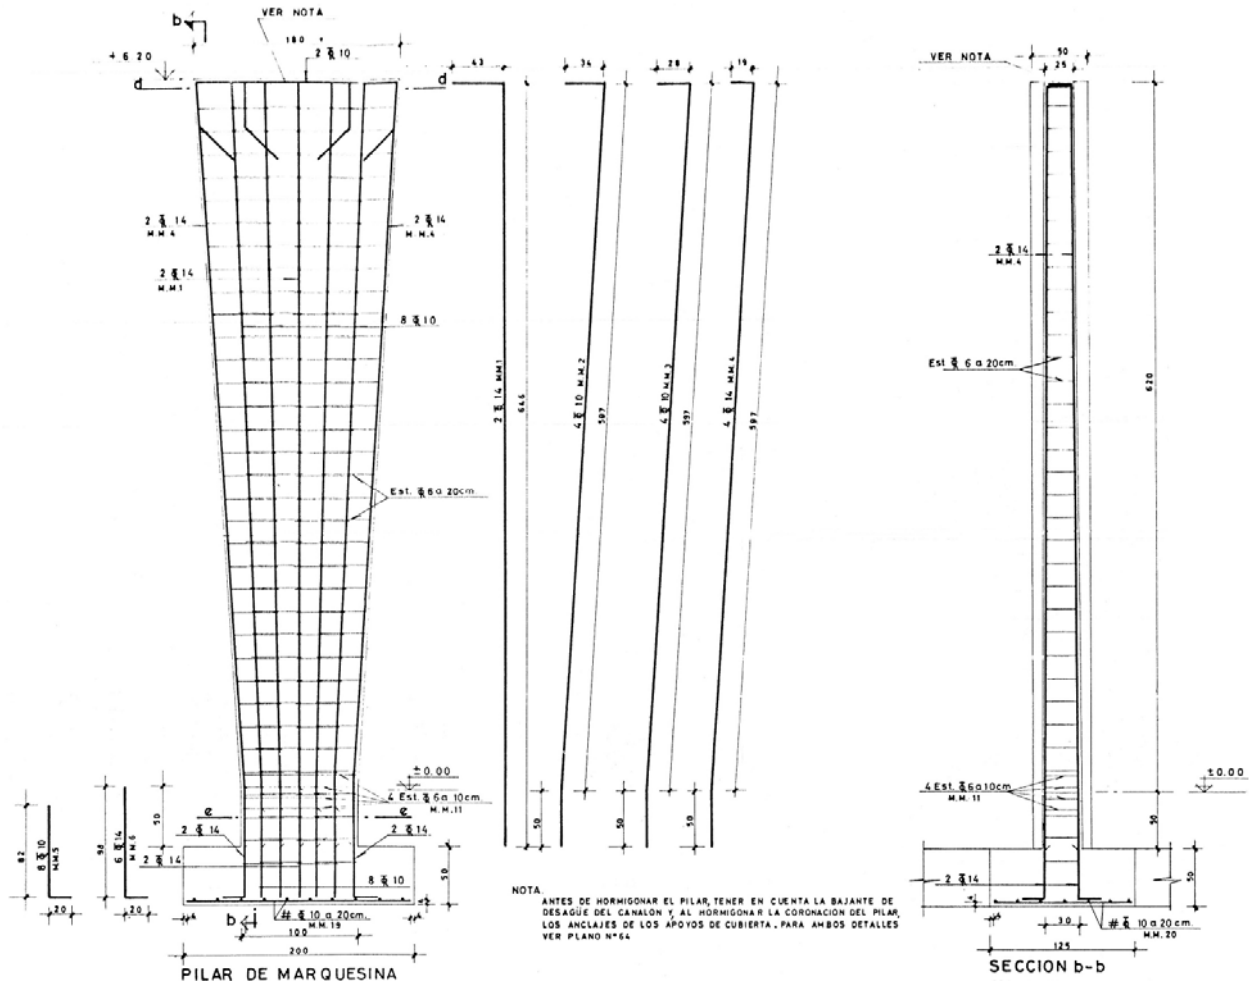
Armado correspondiente al alzado y a la sección transversal vertical de los soportes de la marquesina.
